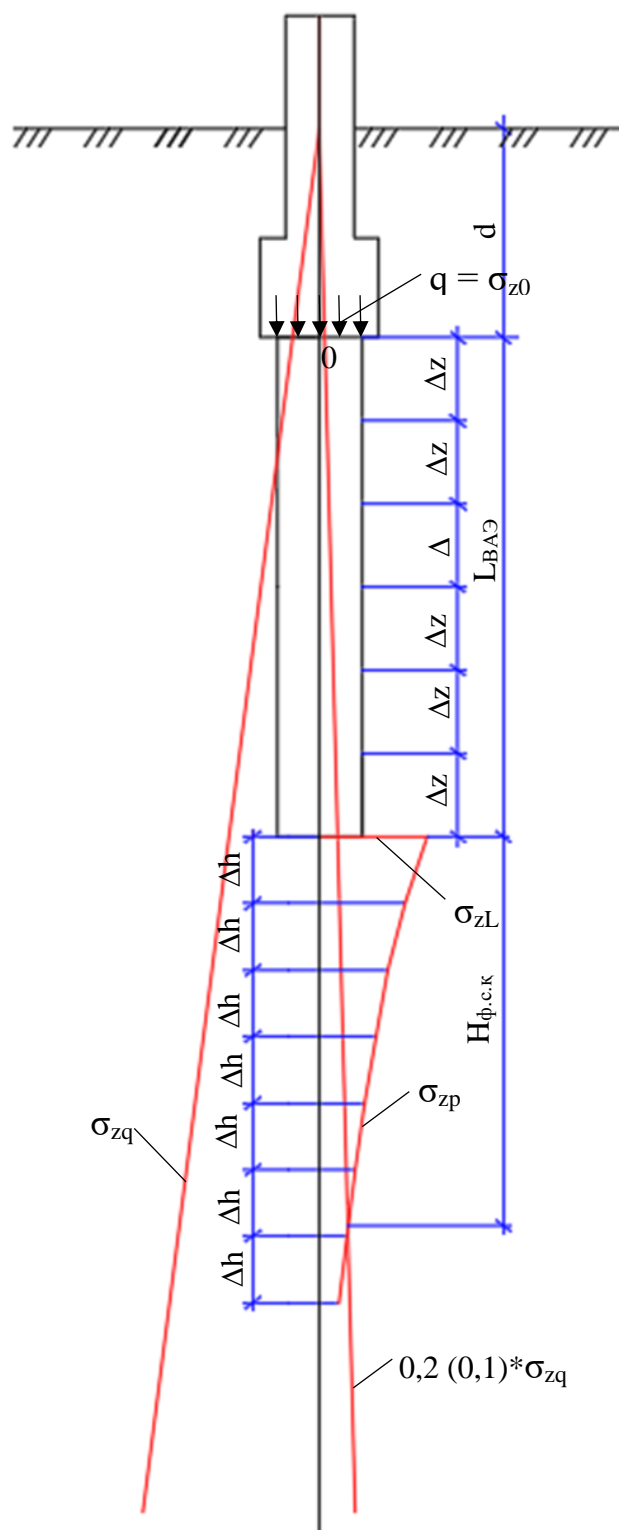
Расчетная схема для определения осадки фундаментов на основание, укрепленных ВАЭ.
